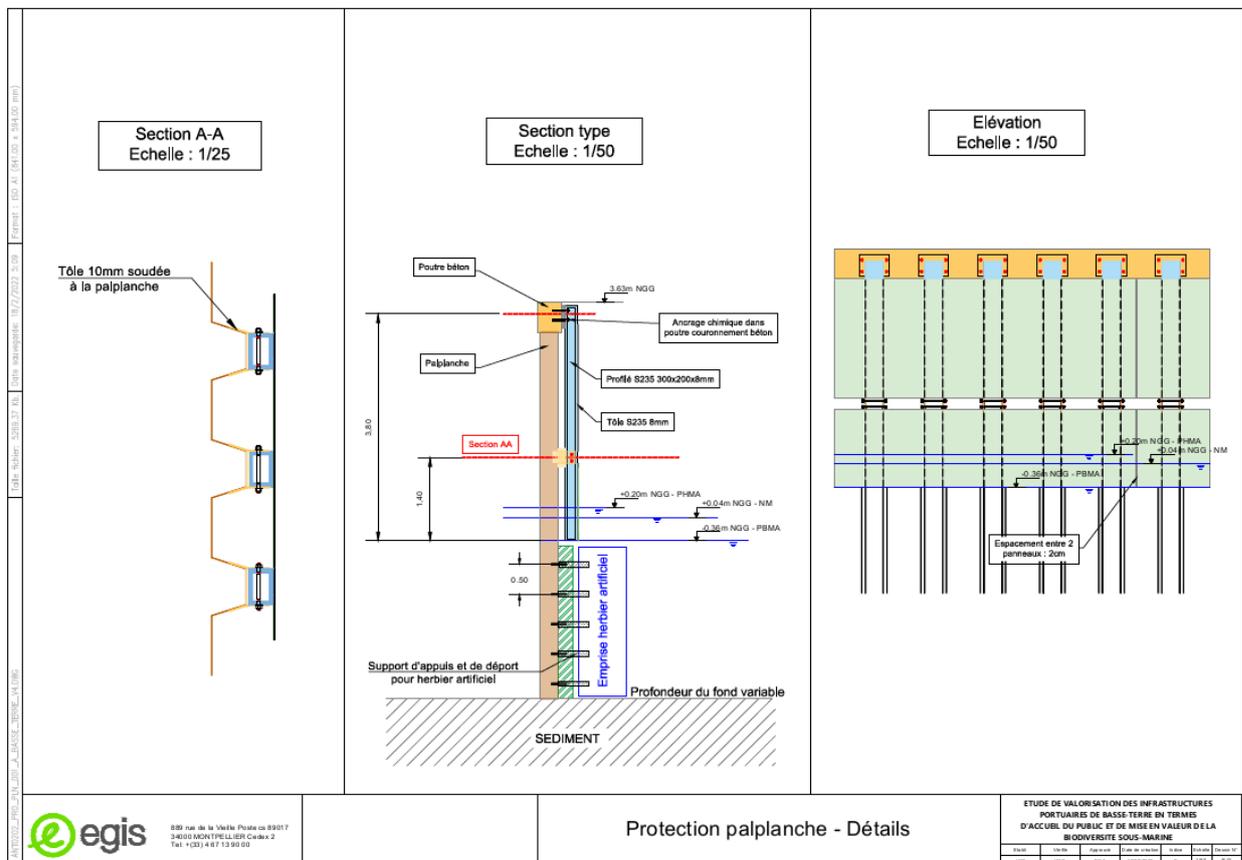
Protection palplanche – Détails (EGIS, 2022)
